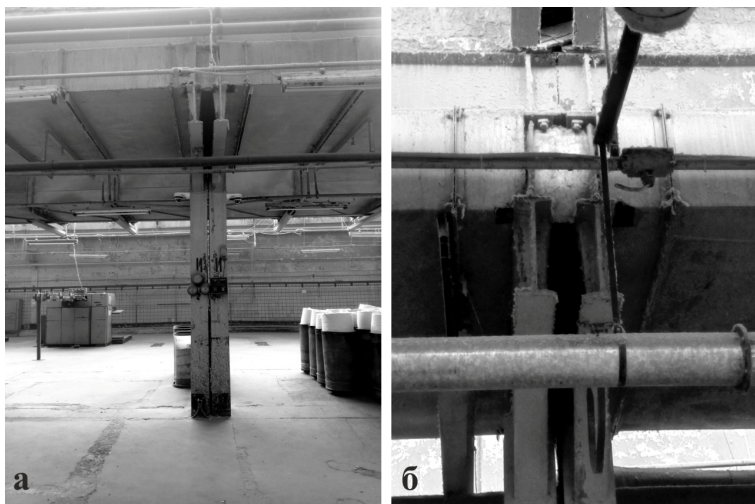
Температурные швы: а — двойные колонны вдоль температурного шва; б — узел опирания горизонтальной двутавровой балки 30а на подкрановую балку колонны
